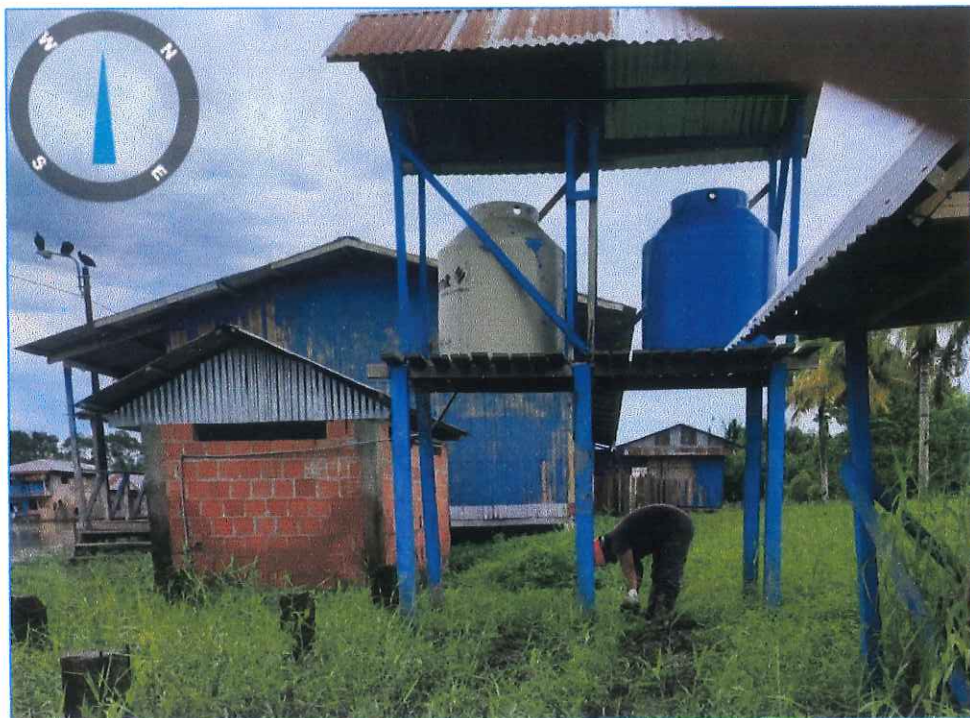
Vista del tanque elevado y pozo tubular construido en el C.P. Pucapanga
